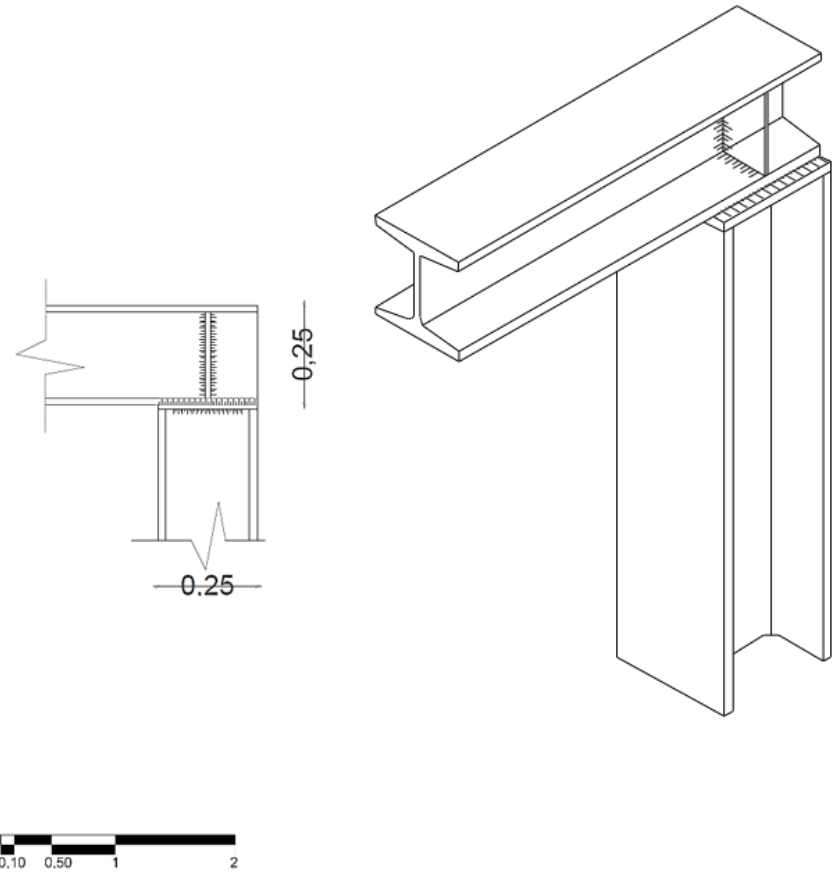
Detalle constructivo c-c del mobiliario de las paradas más utilizadas, escala 1:20. Elaboración propia.
